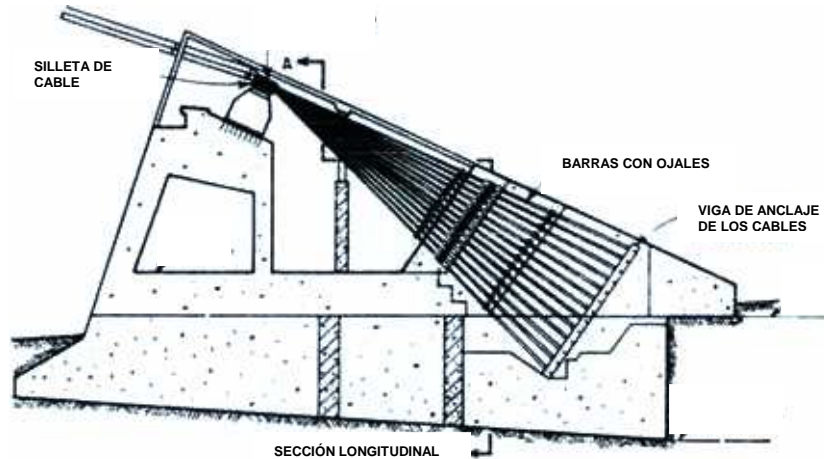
Anclaje de un puente colgante. ¹⁹
